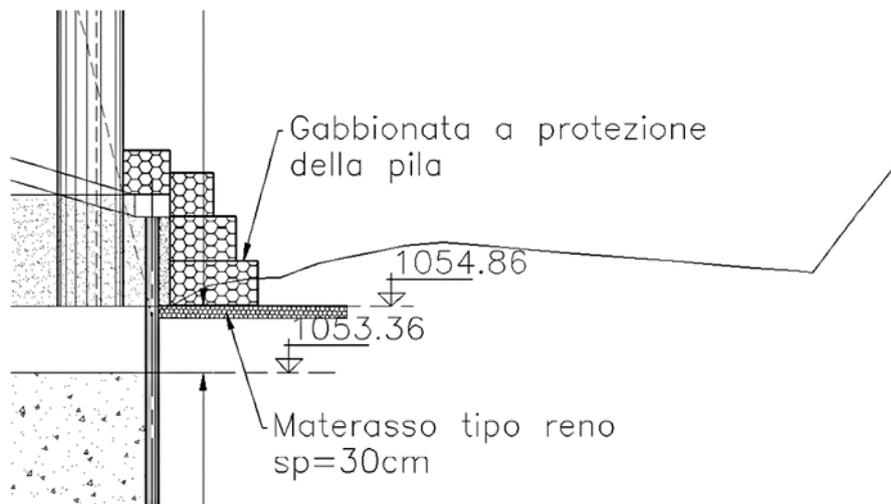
Sezione della sistemazione definitiva del Torrente raio presso la pila 6
